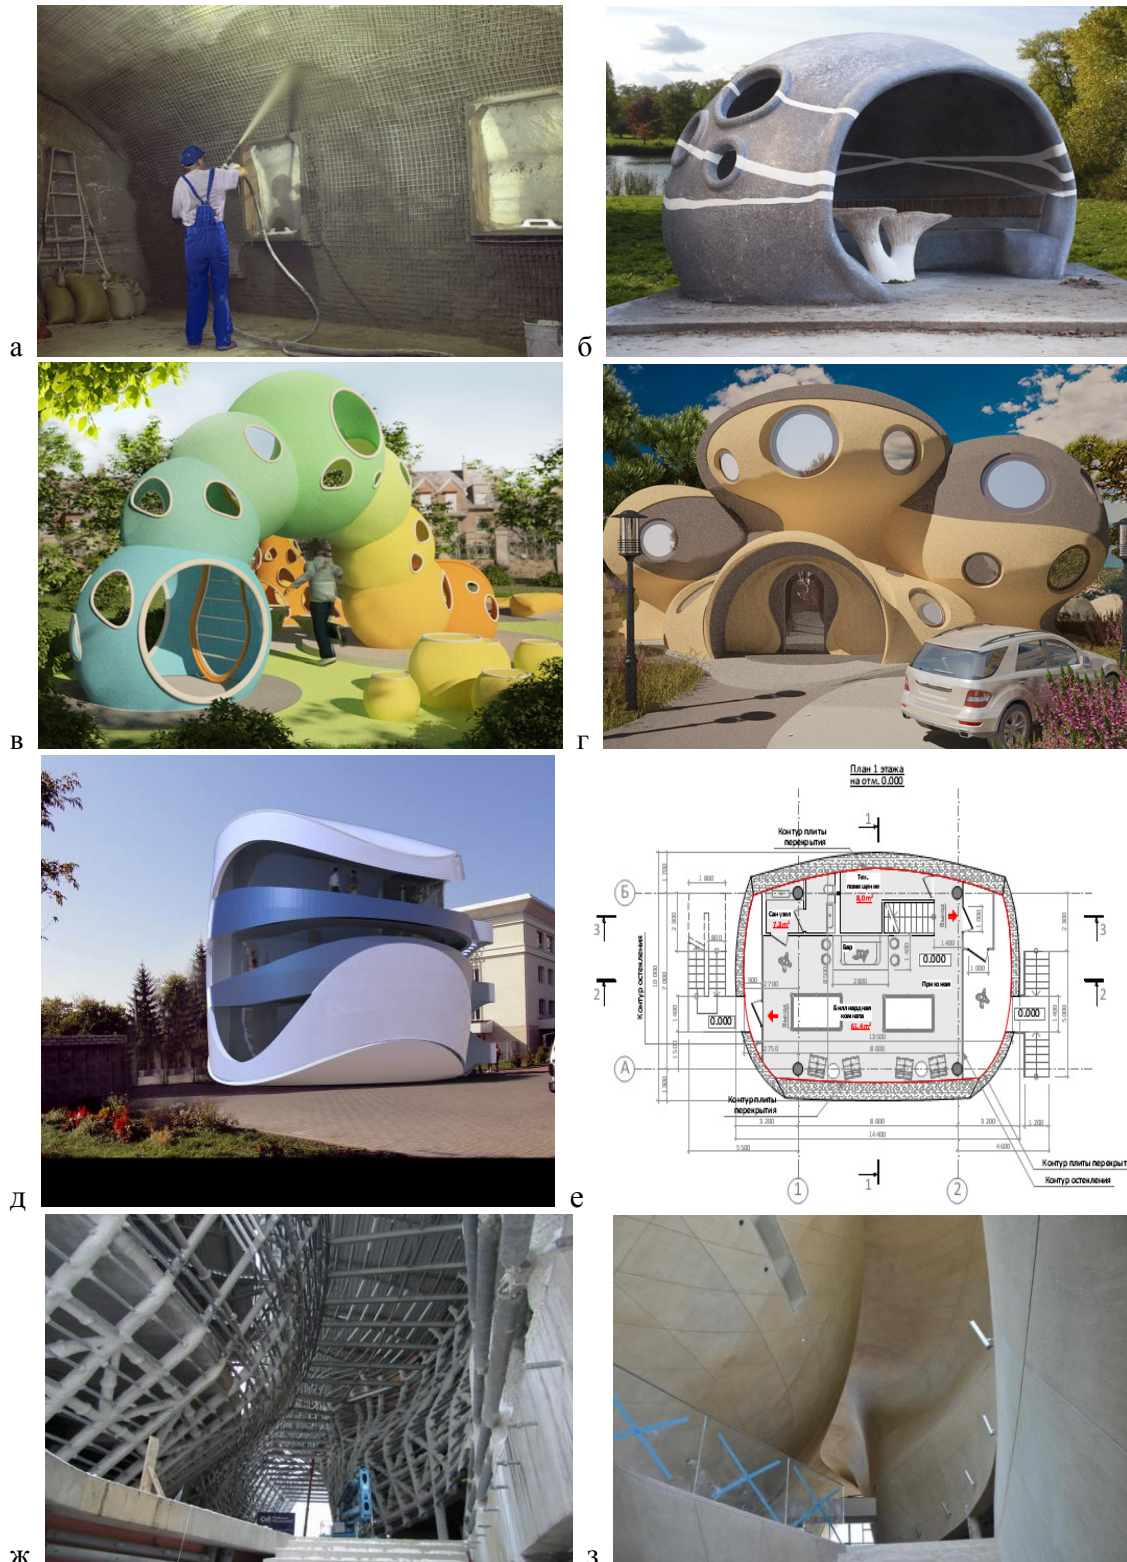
Примеры возведения монолитных железобетонных конструкций с применением торкрет-оборудования: а – торкретирование монолитной оболочки производственного здания; б – конструкция беседки; в, г – варианты проекта детской площадки и жилого дома; д, е – вариант проекта гостиницы для отдыха летчиков в аэропорту г. Харькова (система «Монофант»); ж, з – металлический каркас и внутренние помещения «Музея истории польских евреев» (Польша, г. Варшава)
